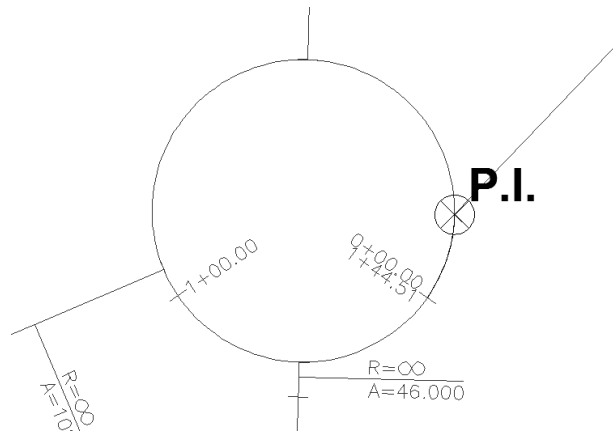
Intersecção em Planta entre o eixo do Ramo 4 e a Rotunda A
